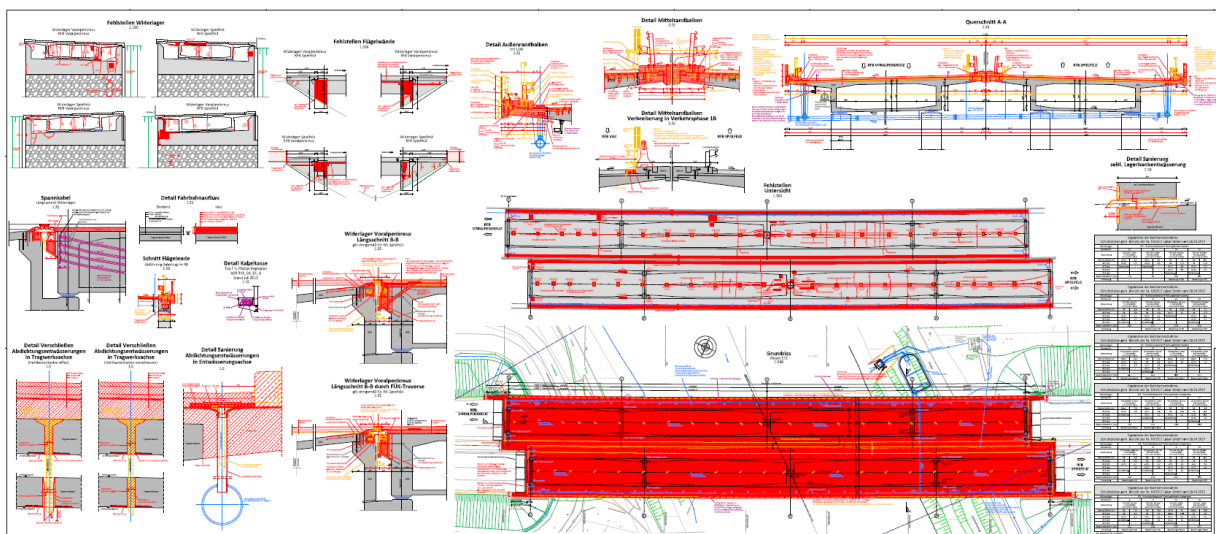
Sanierungsfläche 1 und 2 (mit grün markiert) - Plan: Sanierung Brückenbauwerk E32 Gabersdorf
